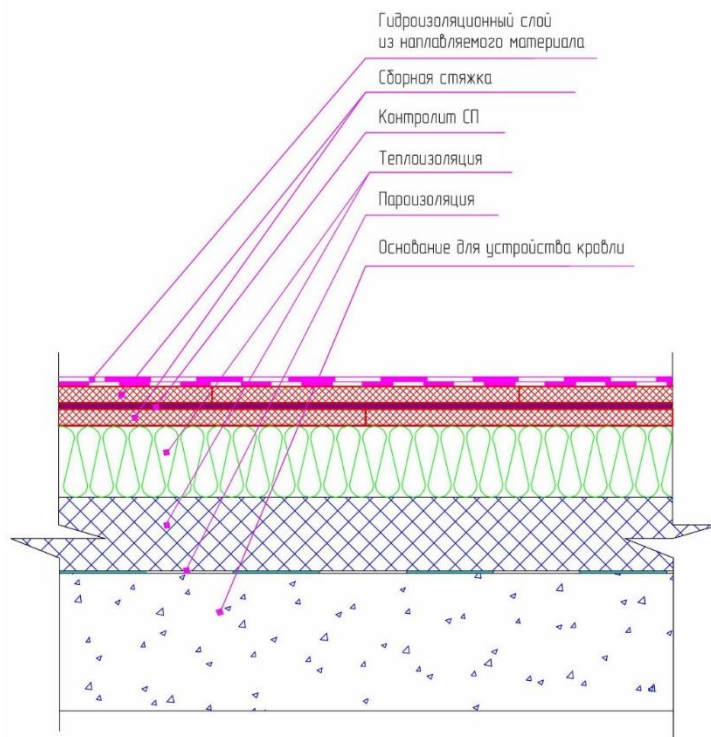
Схематичное расположение слоев кровли со стяжкой «Контролит» на плоской кровле
